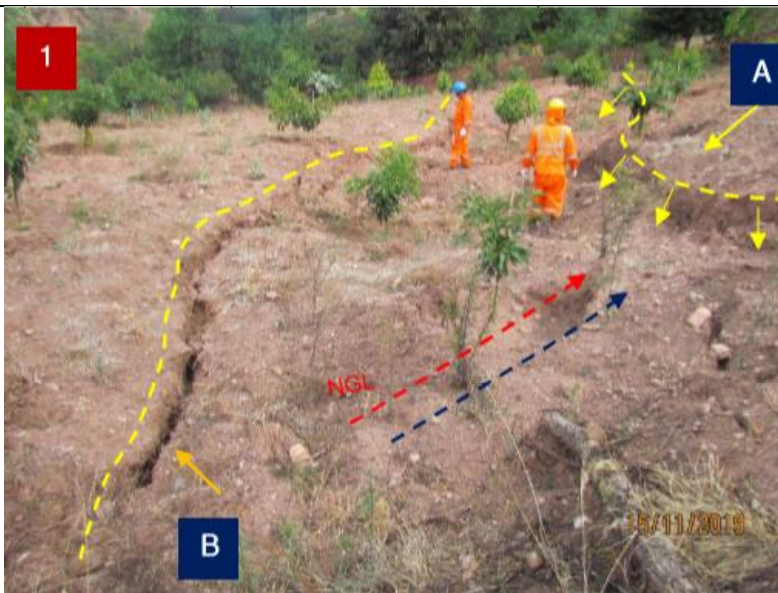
Vista del DdV en el KP 243+900, con grietas y asentamiento transversal al DdV, en suelos arenosos y limo arcillosos, nótese: A (asentamiento Transversal al DdV) y B (grietas en el DdV).
